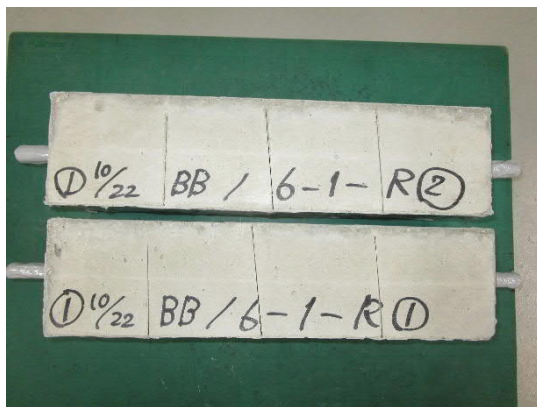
鉄筋コンクリート試験体（ひび割れあり）の詳細
